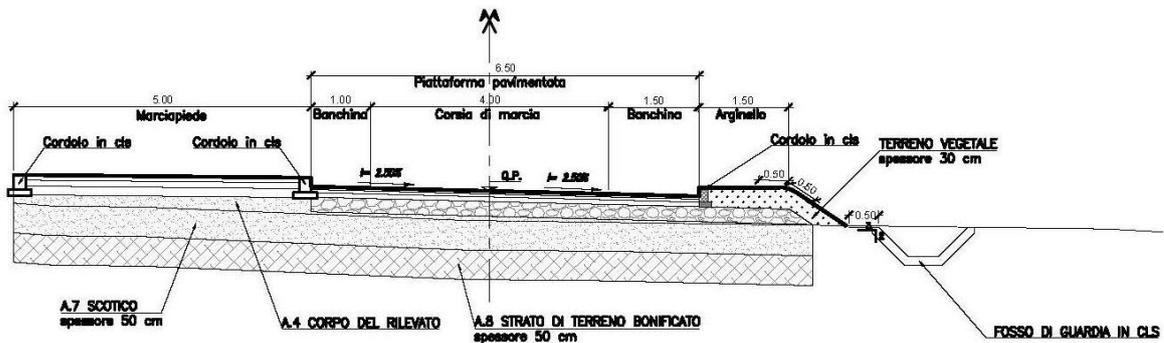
Sezione tipo strada laterale di accesso al parcheggio
